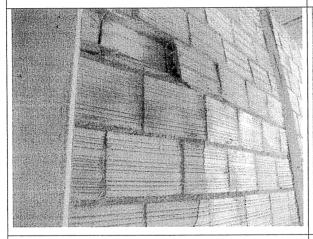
Fisura vertical en el centro del panel de muro.
